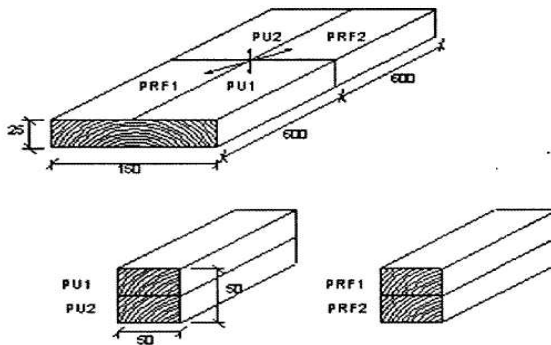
Схема распиловки и сборки скомпонованной пары образцов для испытания на *изогнутый сдвиг
